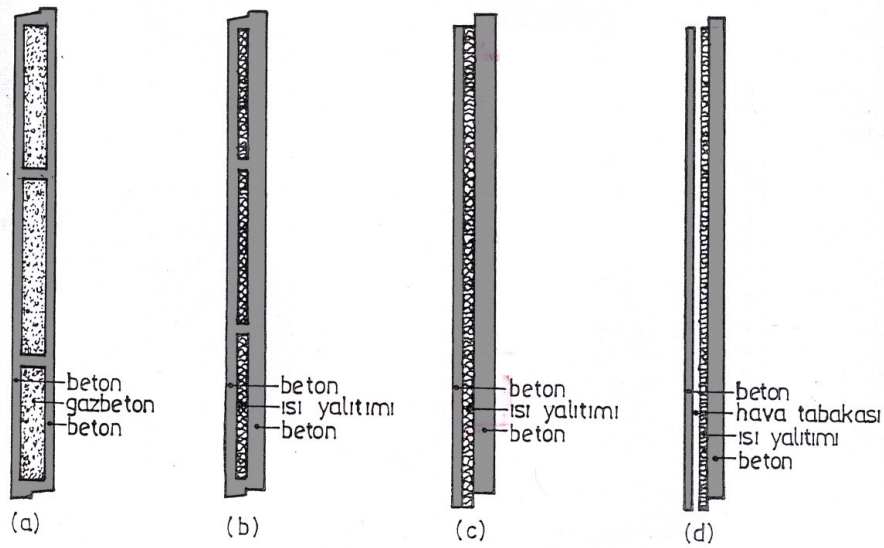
Çift tabakalı beton esaslı panel kesitleri [42]. a)beton ve tuğladan oluşan cephe paneli b, c, d) beton ve gazbetondan oluşan cephe paneli
